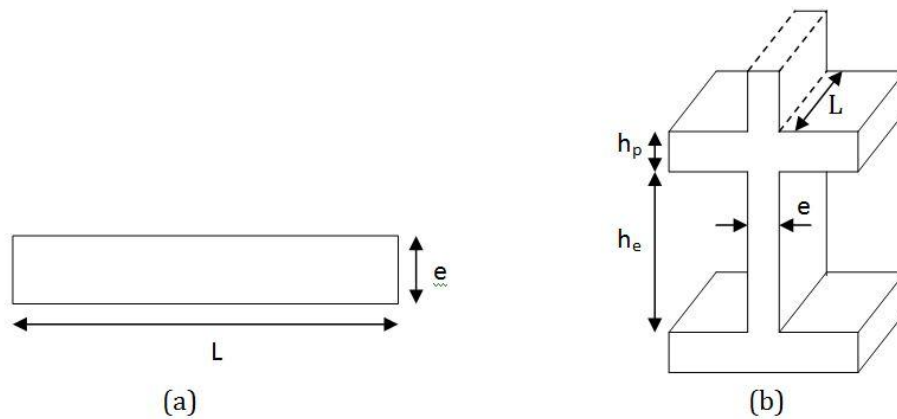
Coupe d'un voile (a) en plan ; (b) en élévation.
